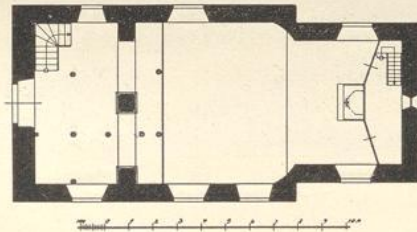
Kirche in Wassel; Grundriss
